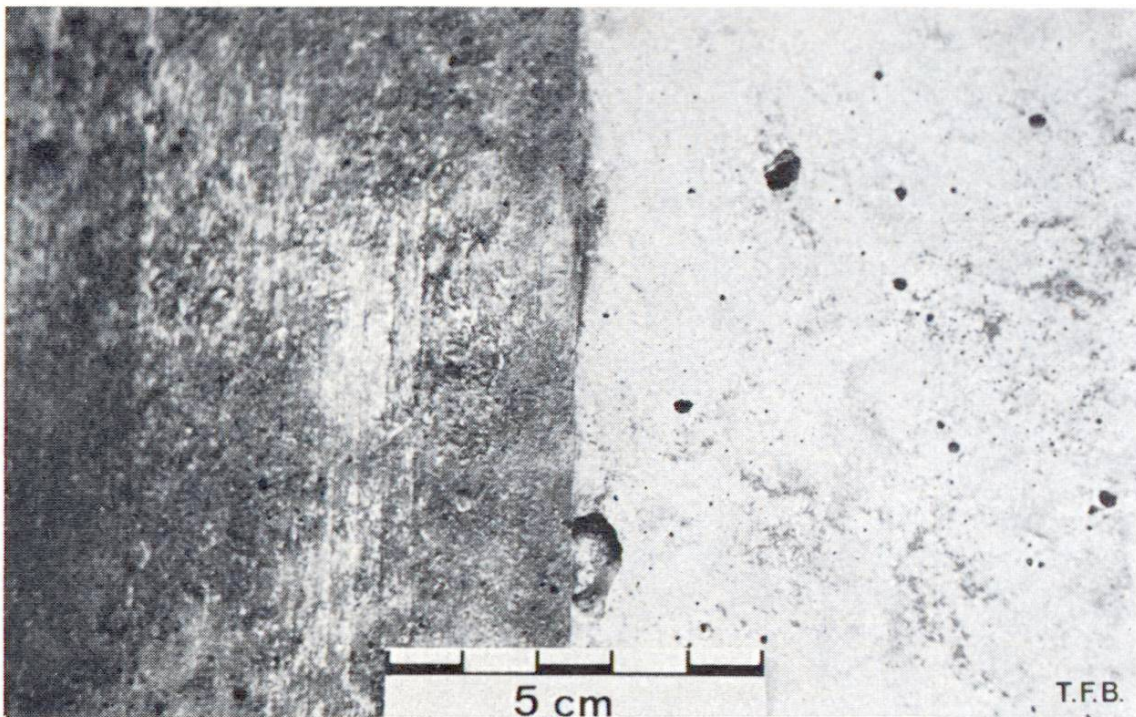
Dans un même élément de béton, il y a davantage de soufflures à droite où le coffrage était lisse.
